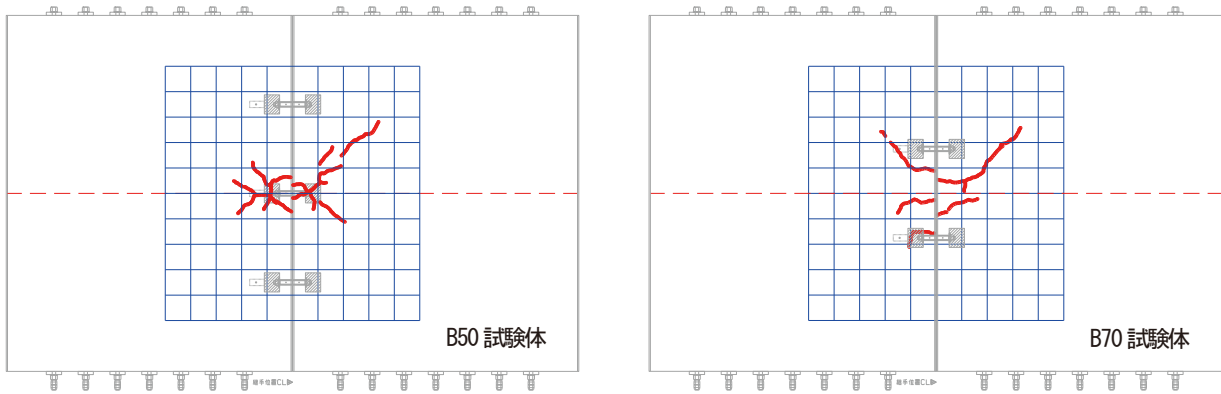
255kN 荷重 10 万回終了後のひび割れ状況
